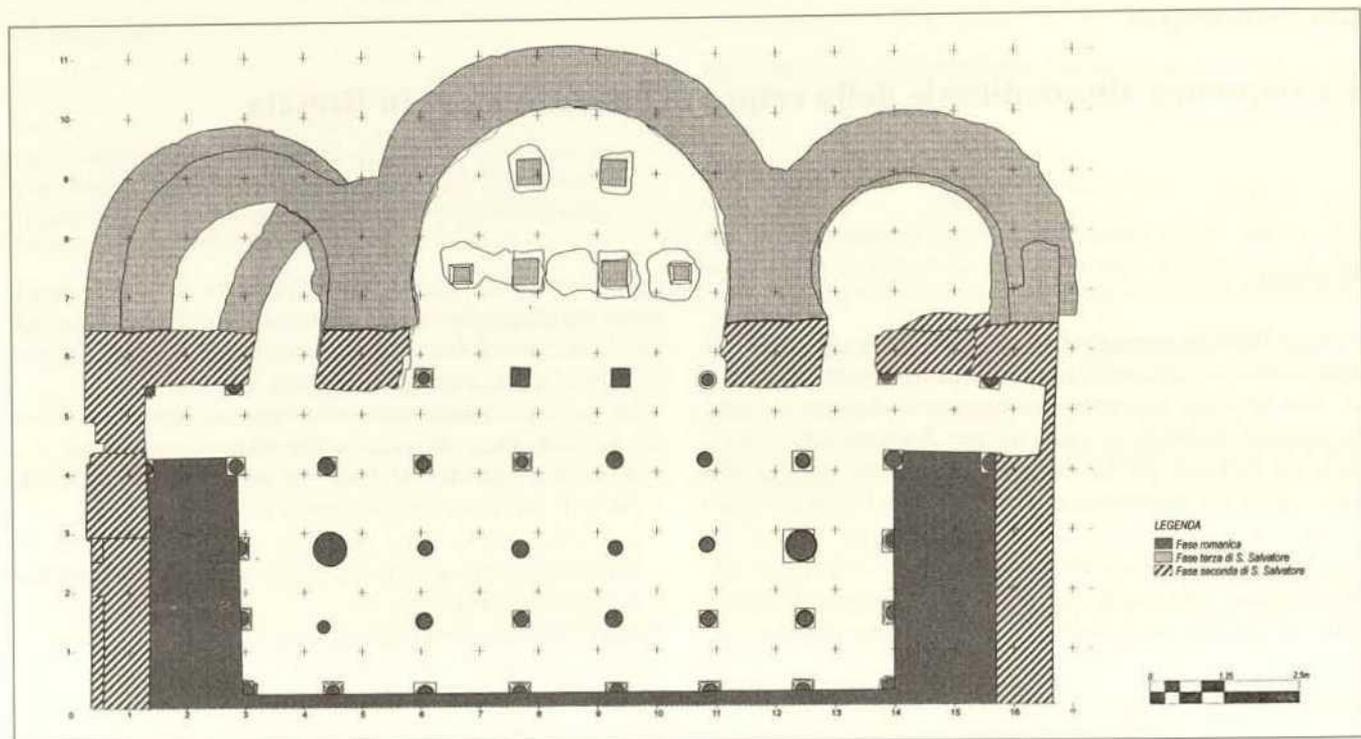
Brescia, San Salvatore, Krypta, Grundriß mit Bauphasenscheidung / pianta della cripta (Zeichnung: A. Maifreni, D. Baldini).
